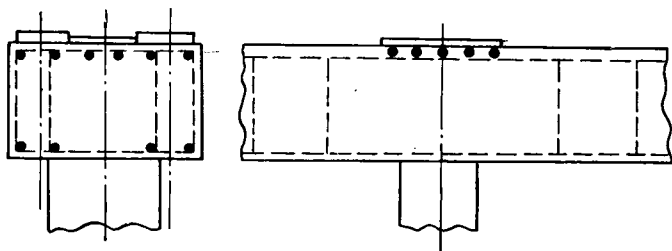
Армирование насадки специальной поперечной арматурой (существующая по типовому проекту арматура показана пунктиром)
